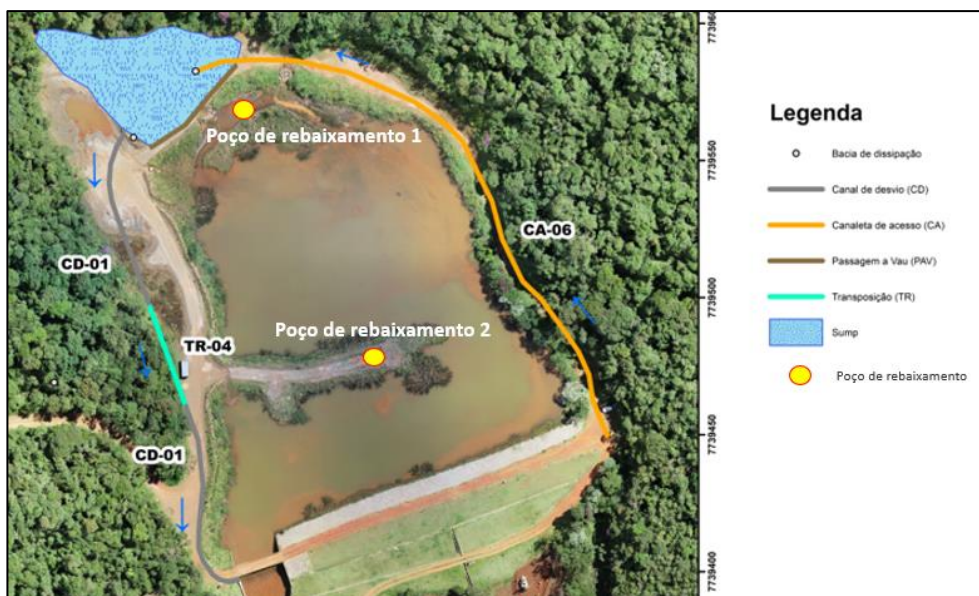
Sistema de desvio e poços de rebaixamento – Projeto executivo
